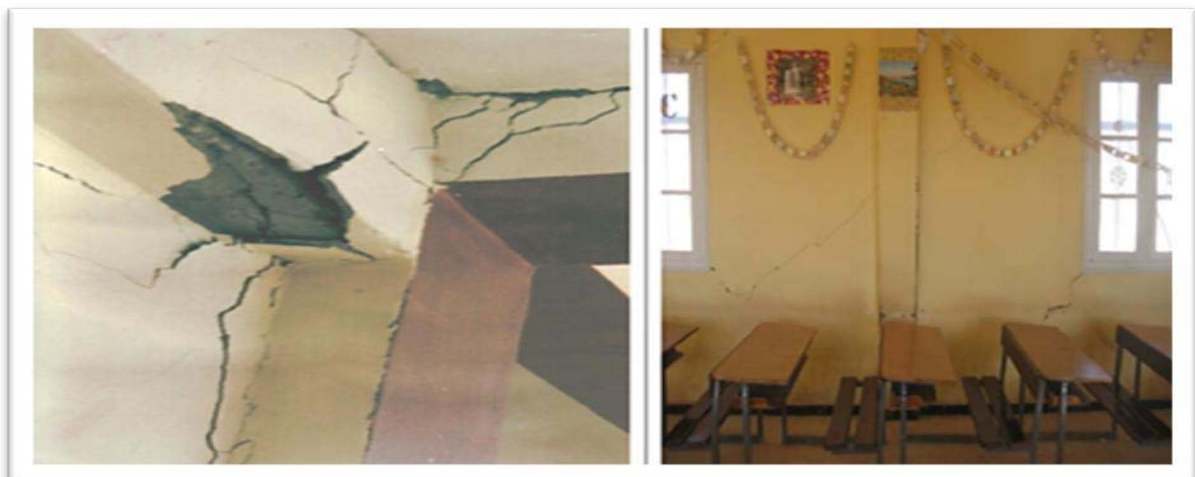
fissuration des poutres et des murs à Ain Hadjel.
